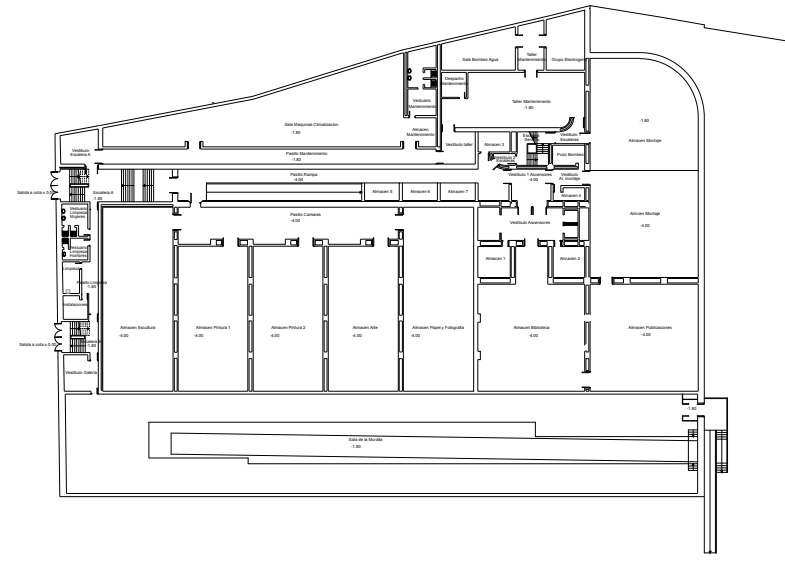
Planta Sótano del IVAM. E: 1/1000.
